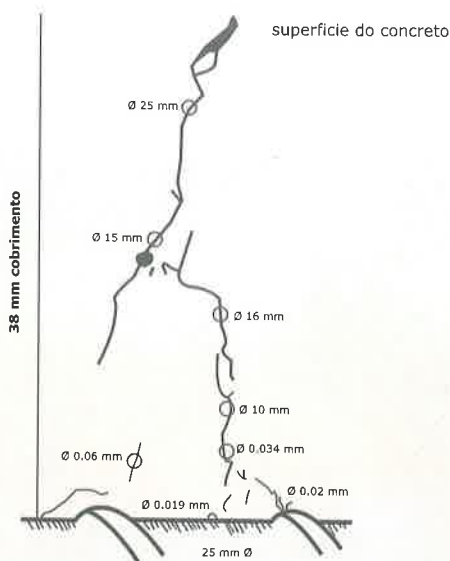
Fissura provocada pelo aumento de volume da armadura.
